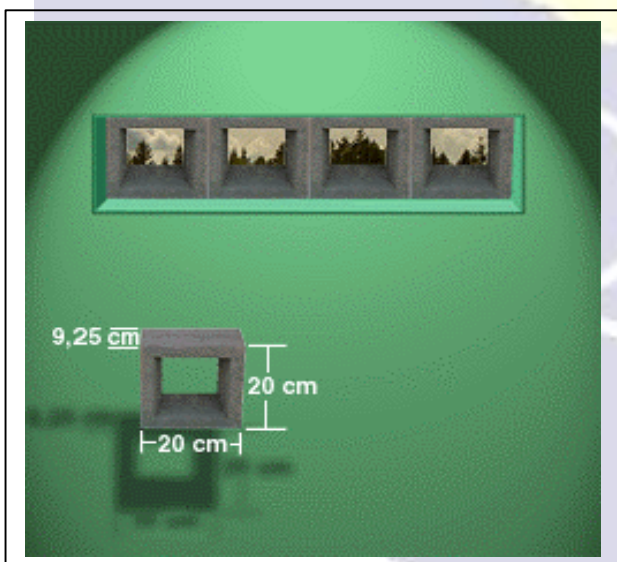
Elemento vazado de argamassa de cimento, regular, 20,0 X 20,0 cm
